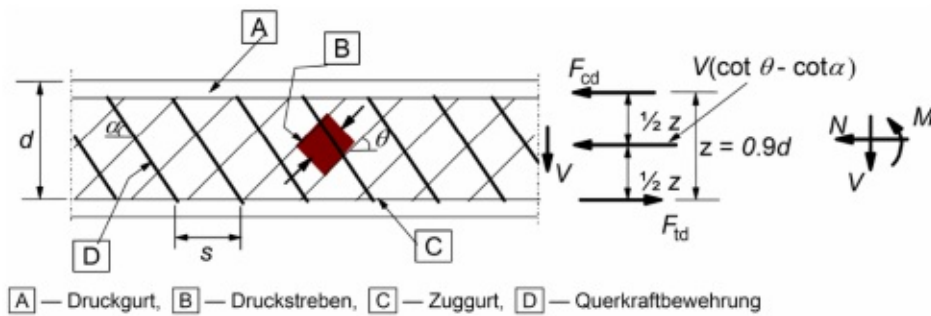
Fachwerkmodell mit Querkraftbewehrung, aus [19](modifiziert)
